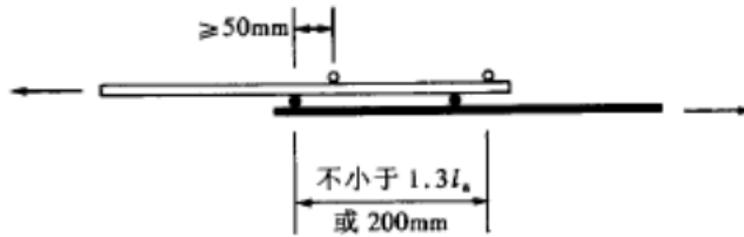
冷拔钢筋焊接网搭接接头
